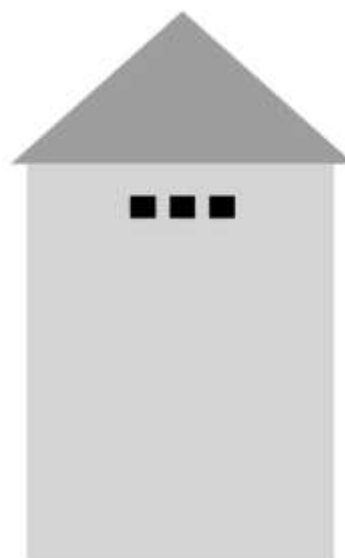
Pigeonnier isolé de plan carré ou rectangulaire
